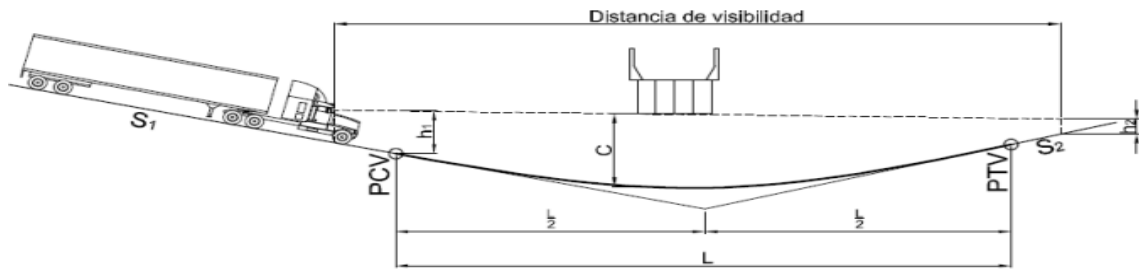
Elementos para determinar el ángulo bajo estructuras
